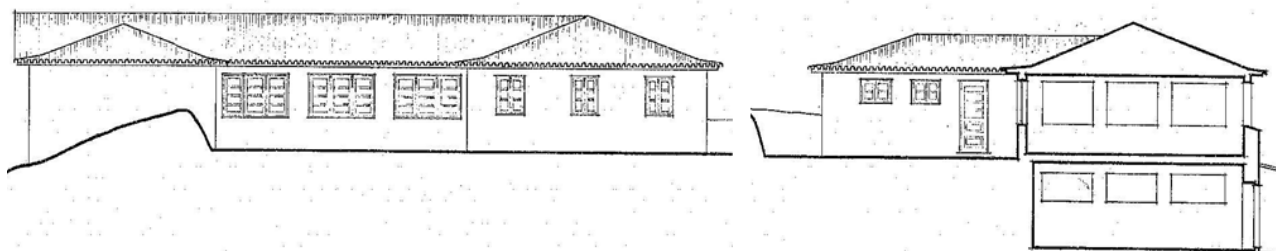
Fachada posterior e corte transversal, respectivamente do edifício H a construir, designado como Colónia Balnear Infantil, Dormitório (fonte: idem).
